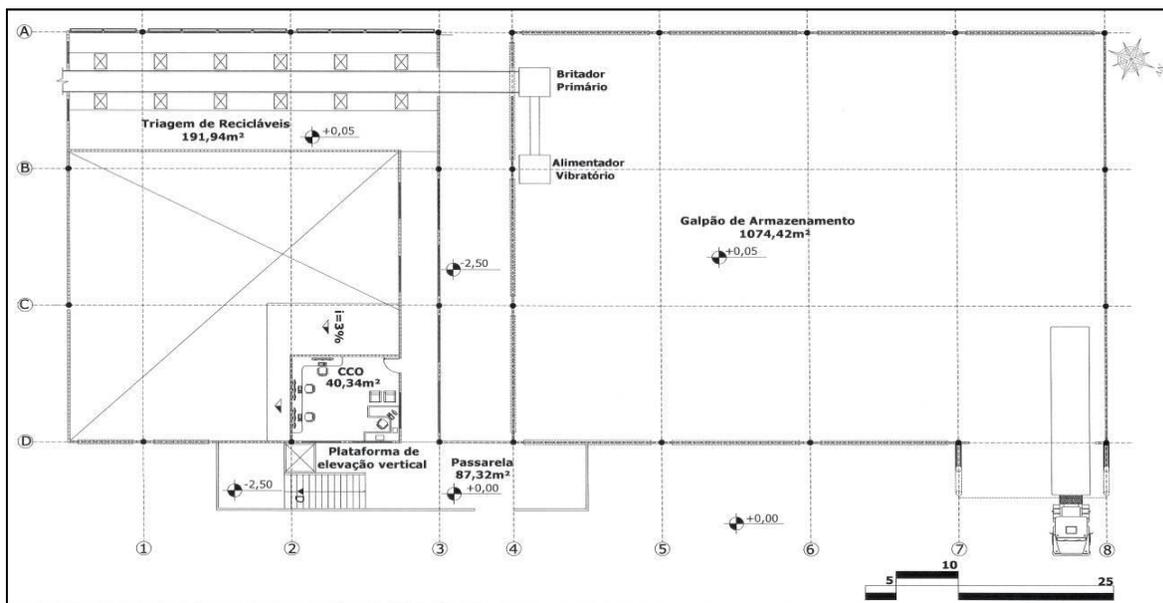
Galpão de Armazenamento, Triagem e Reciclagem – Planta baixa do pavimento térreo
